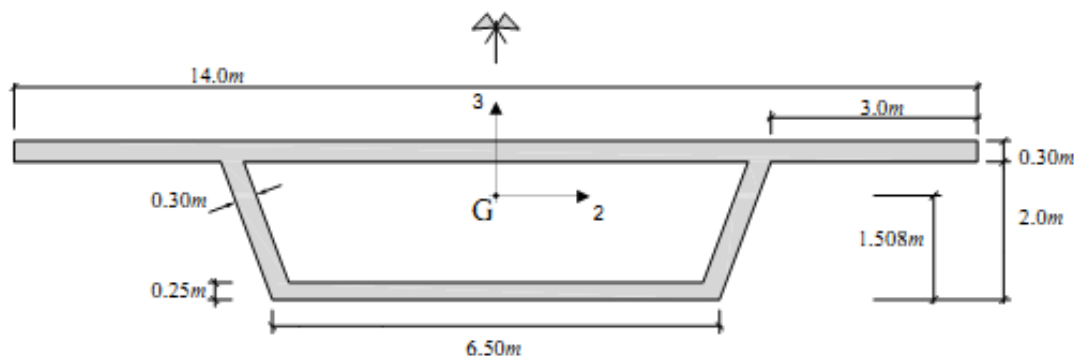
Pormenor da Secção transversal do tabuleiro
